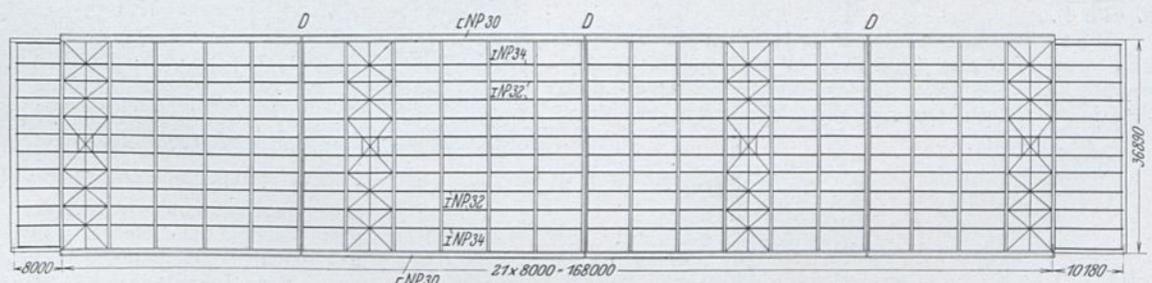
Straßenbahnhof Britz. Grundriß einer Seitenhalle.
